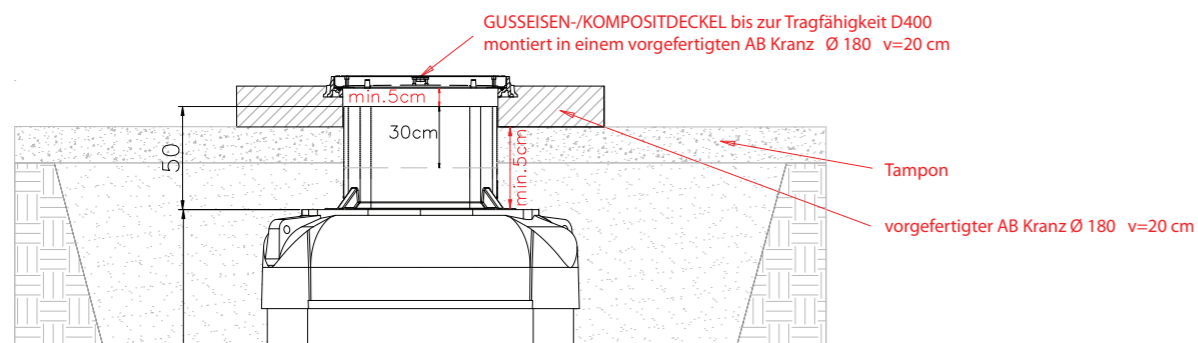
Detail des Einbaus eines AB-Kranzes mit eingebauter Abdeckung auf dem PE-Kabelschacht
